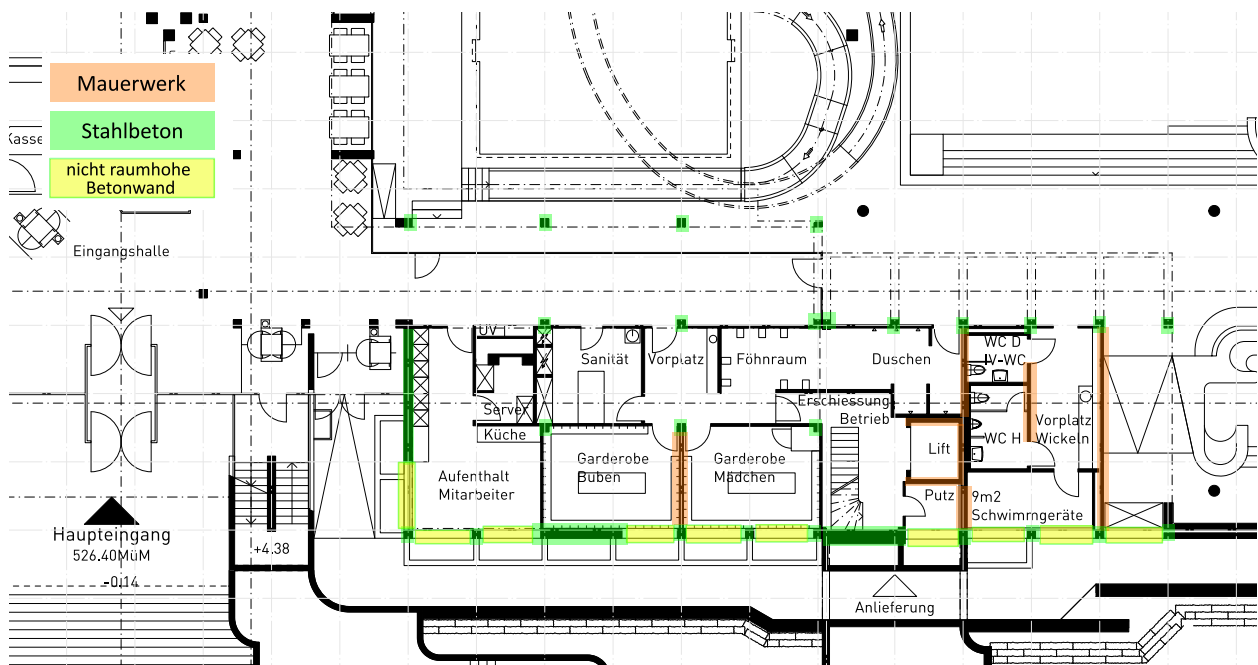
Modellierte tragende Elemente Sauna im Erdgeschoss
